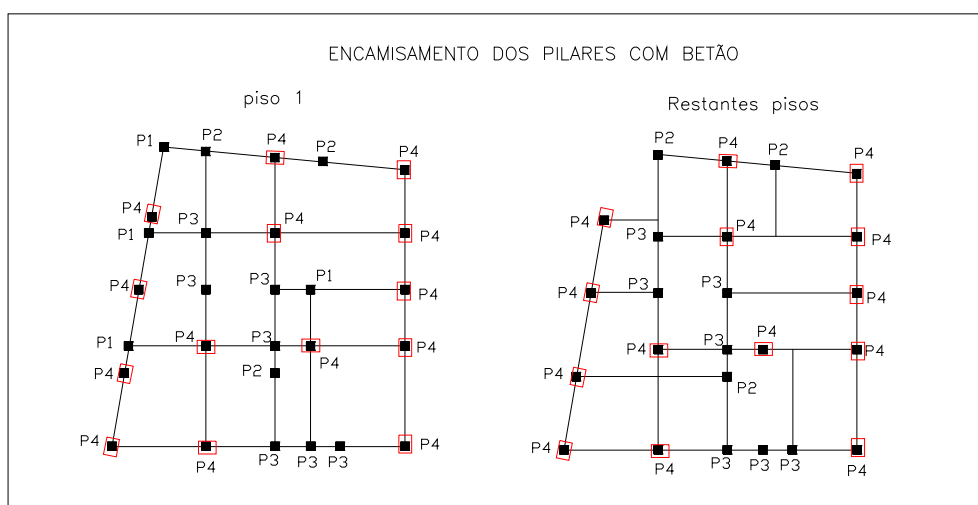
Planta estrutural do edifício reforçado por encamisamento dos pilares existentes.
